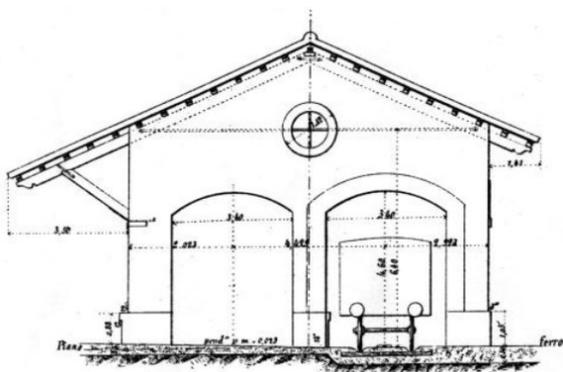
Sezione e prospetto di una Halle Marchandise a struttura mista, espansione datata 1914. Fonte: www.ferrovissime.fr
